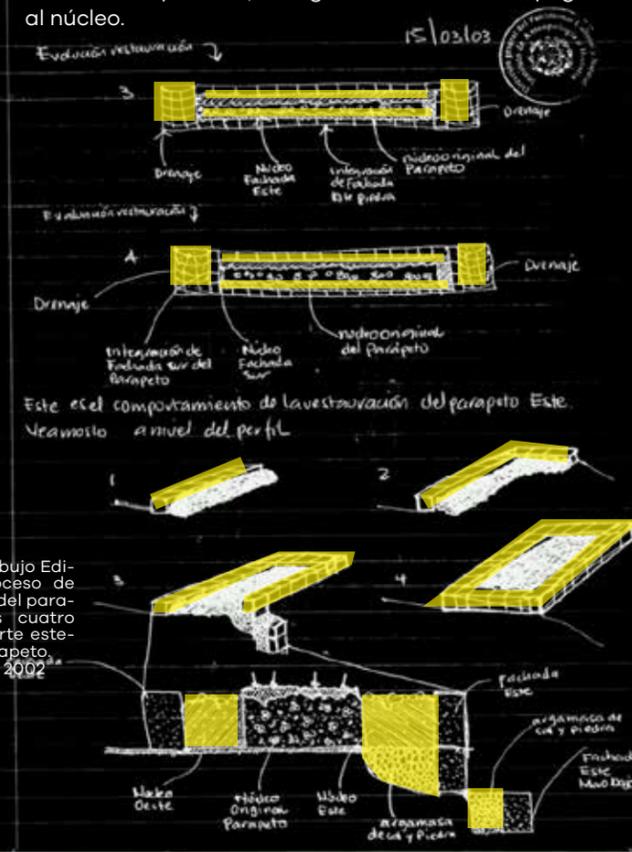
Dibujo Edificio Blom Proceso de restauración del parapeto en sus cuatro fachadas. Corte este-oeste del parapeto. Dibujo: GAMH 2002
